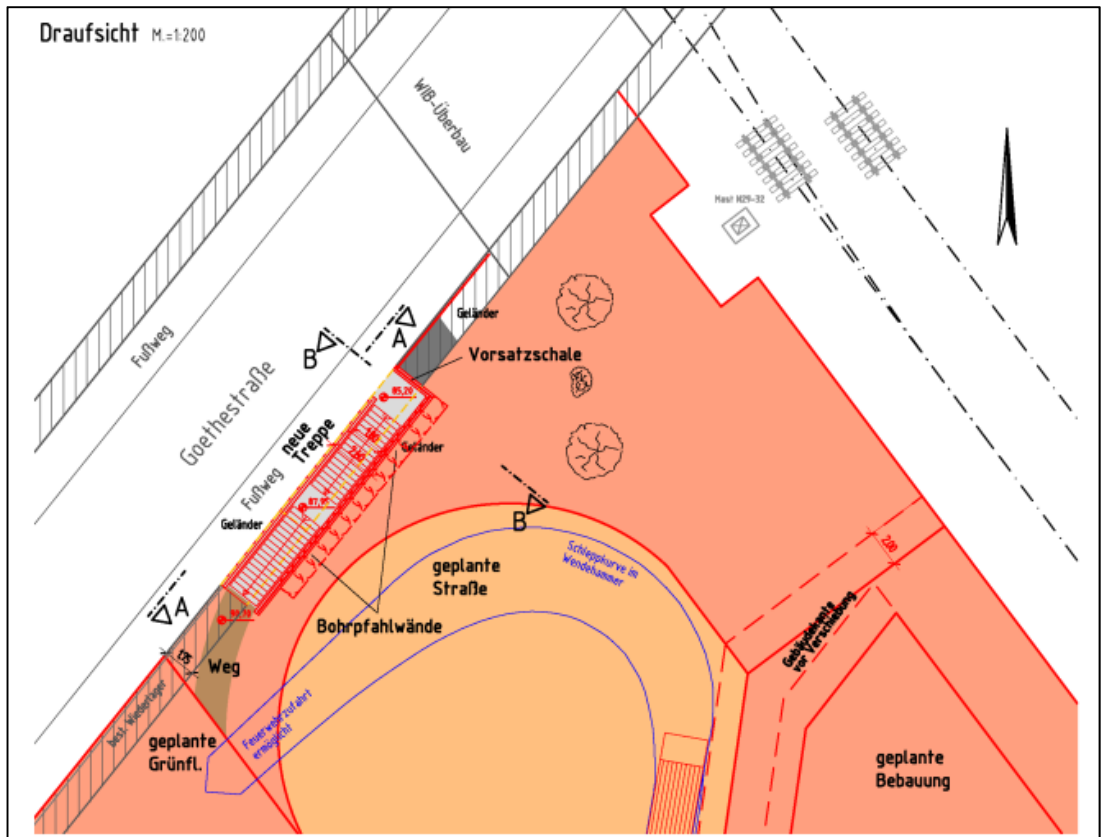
Planung Treppenaufgang Goethestraße (Lageplan).
